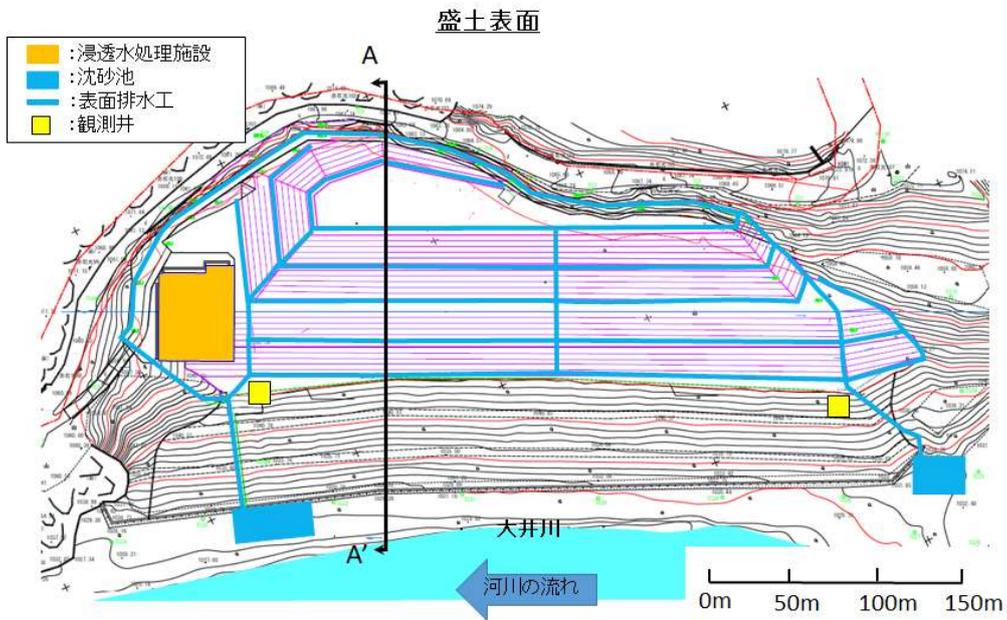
藤島発生土置き場（対策土）の排水設備計画平面図
